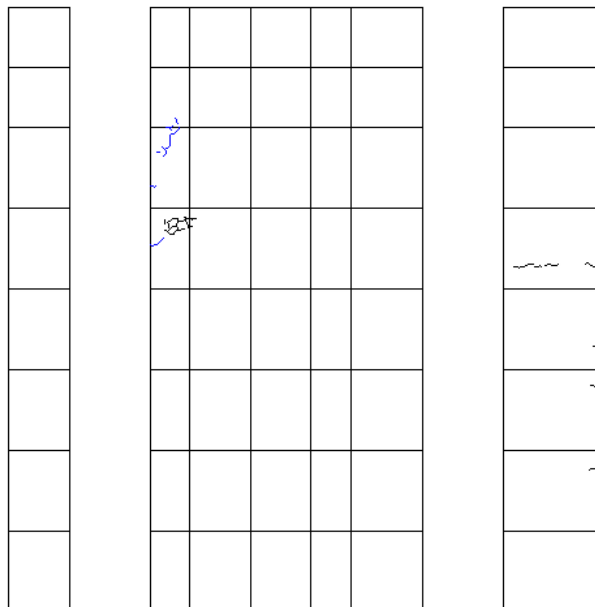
R=1/1600 ひび割れ図
